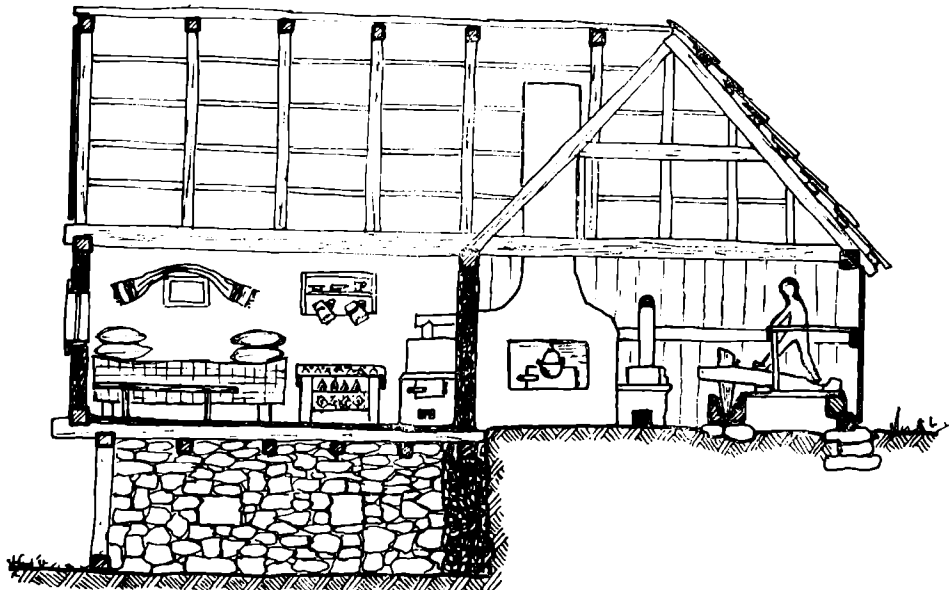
Grundriß und Schnitt der Ölmühle von Nădăștia (Kr. Hunedoara) mit der Stampfe mit Tretanken und der Presse mit handbetriebenem Rad und zweigängiger Schraube, wodurch der Pressvorgang in der Waagerechten stattfindet
